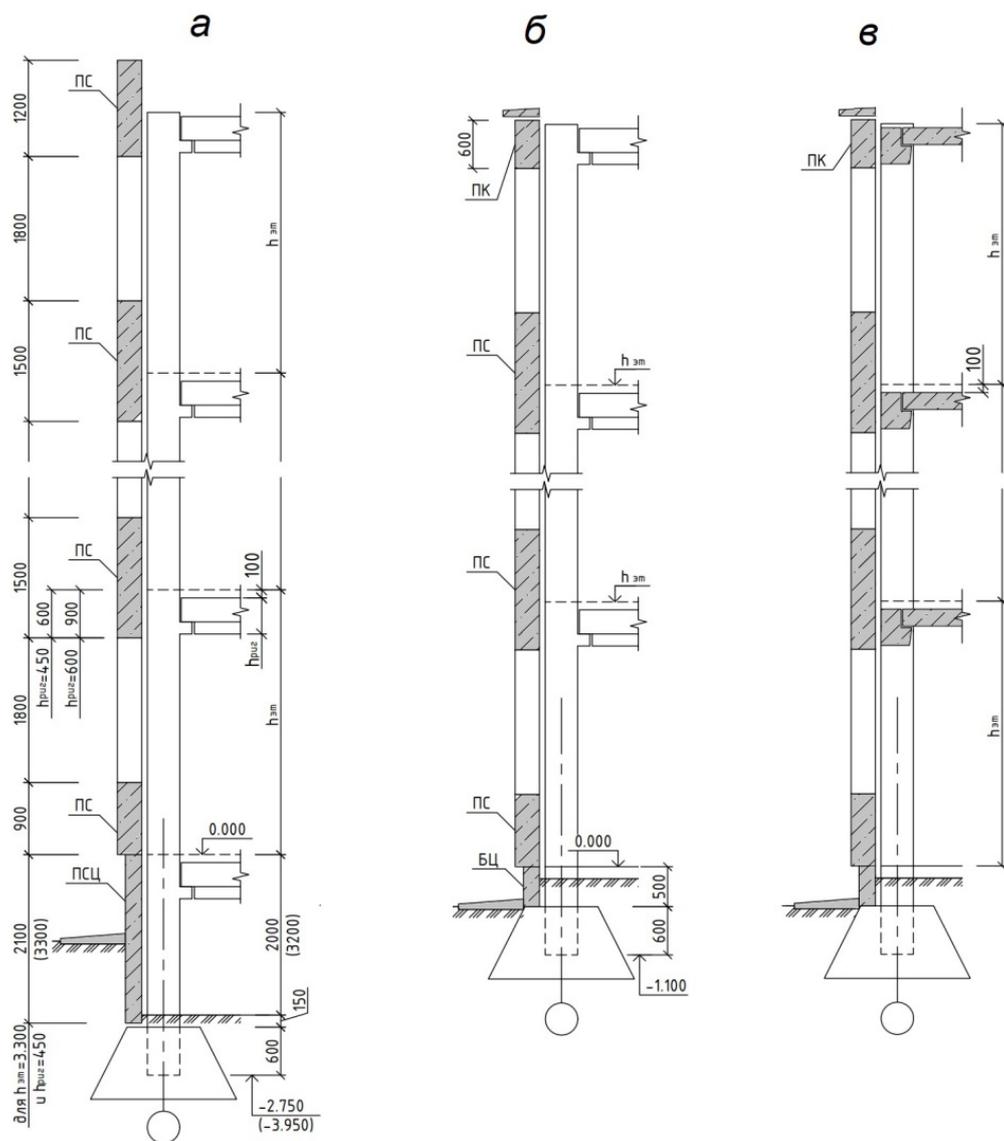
Схемы характерных разрезов здания по наружной стене: *а* — продольной с подвалом и парапетом в покрытии; *б* — продольной без подвала и с карнизом в покрытии; *в* — торцевой без подвала и с карнизом в покрытии
